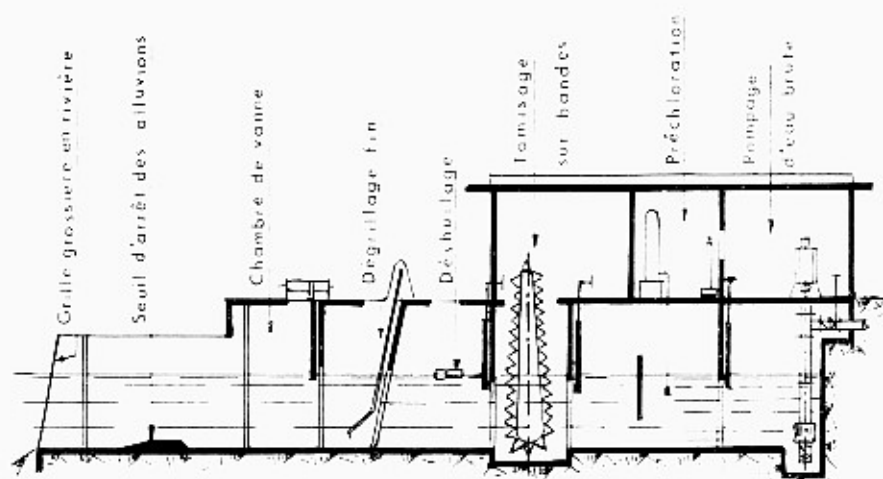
b* — Groupement de la prise sur berge et de quelques installations annexes.
